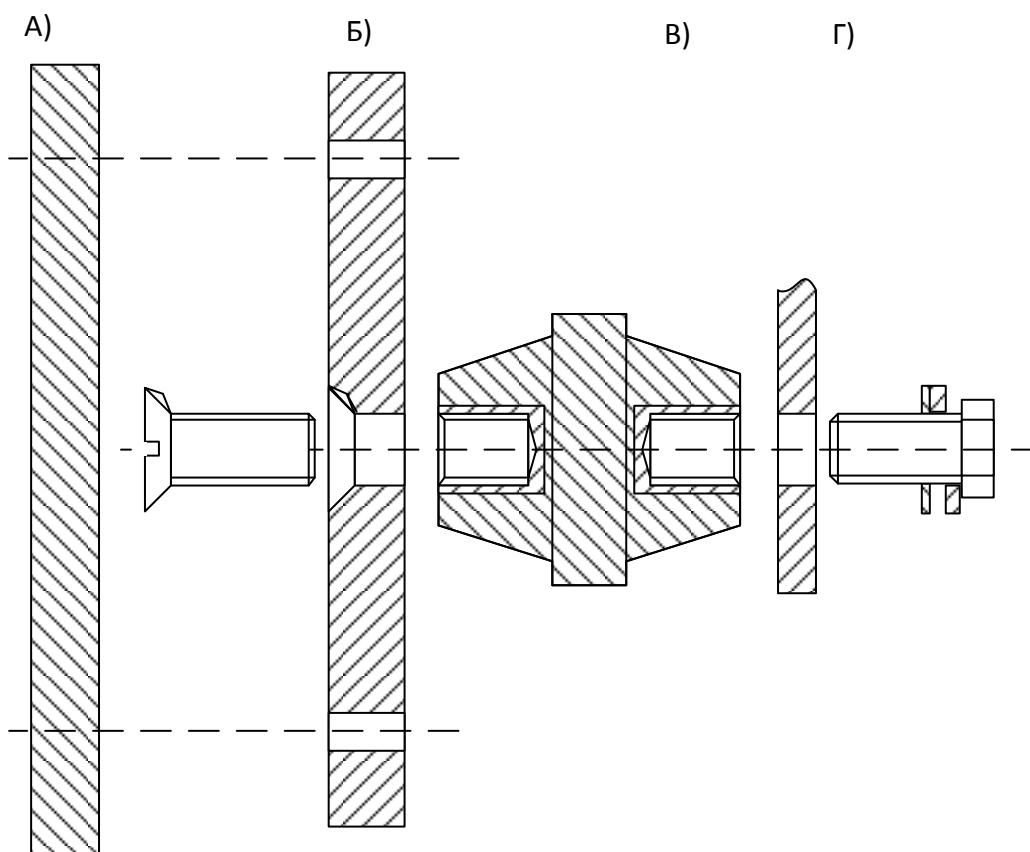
Порядок монтажа площадки, изолятора и шины(А,Б -разметка стены и монтаж площадки; В-установка изолятора на площадку; Г- крепление шины к изолятору).
